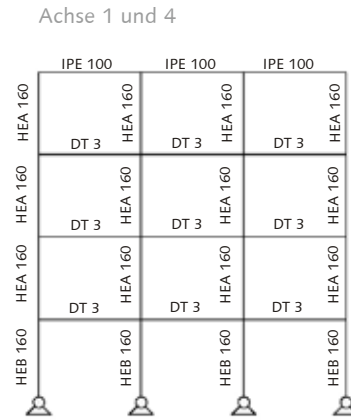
Grundriss Rahmen II - Haus 1
